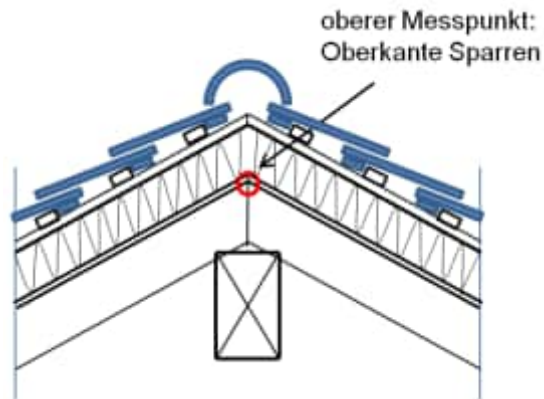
Dachquerschnitt. Alle Bauelemente oberhalb der Sparren (Dacheindeckung, Latung/Konterlattung, Unterdach, ggf. Isolation oberhalb der Sparren) zählen nicht zur Dachkonstruktion (Quelle: Leitfaden zur Harmonisierung der Baubegriffe vom 1. März 2017)
